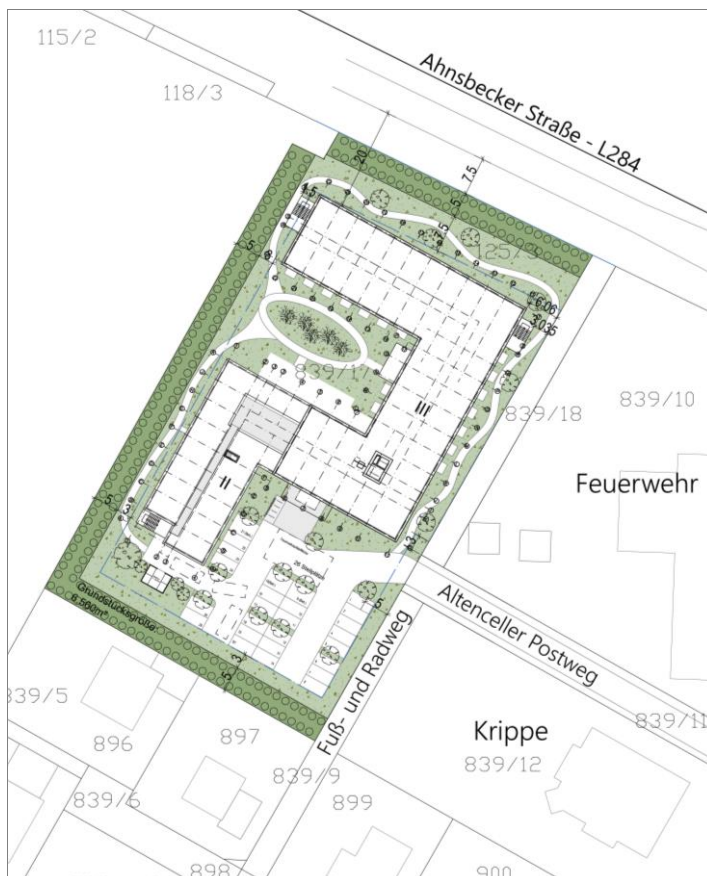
Lageplan Seniorenpflegeheim (Kuhn Pramann Architekten, Stand 13.01.22)
